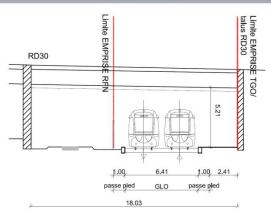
Vue en coupe (AA' sur vue en plan) de l'ouvrage sous la RD 30
